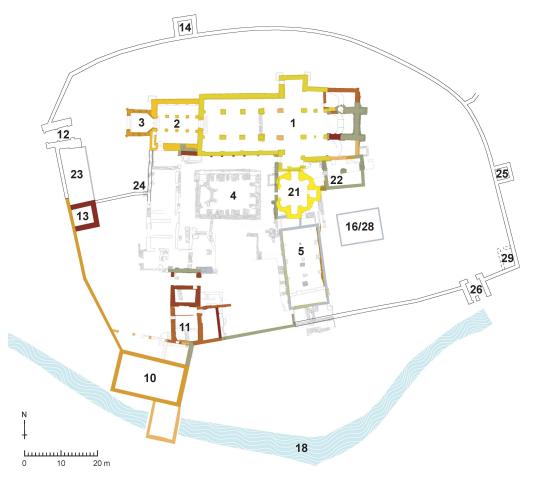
Plan schématique après la construction du grenier en 1580. Éch. 1:1000.
